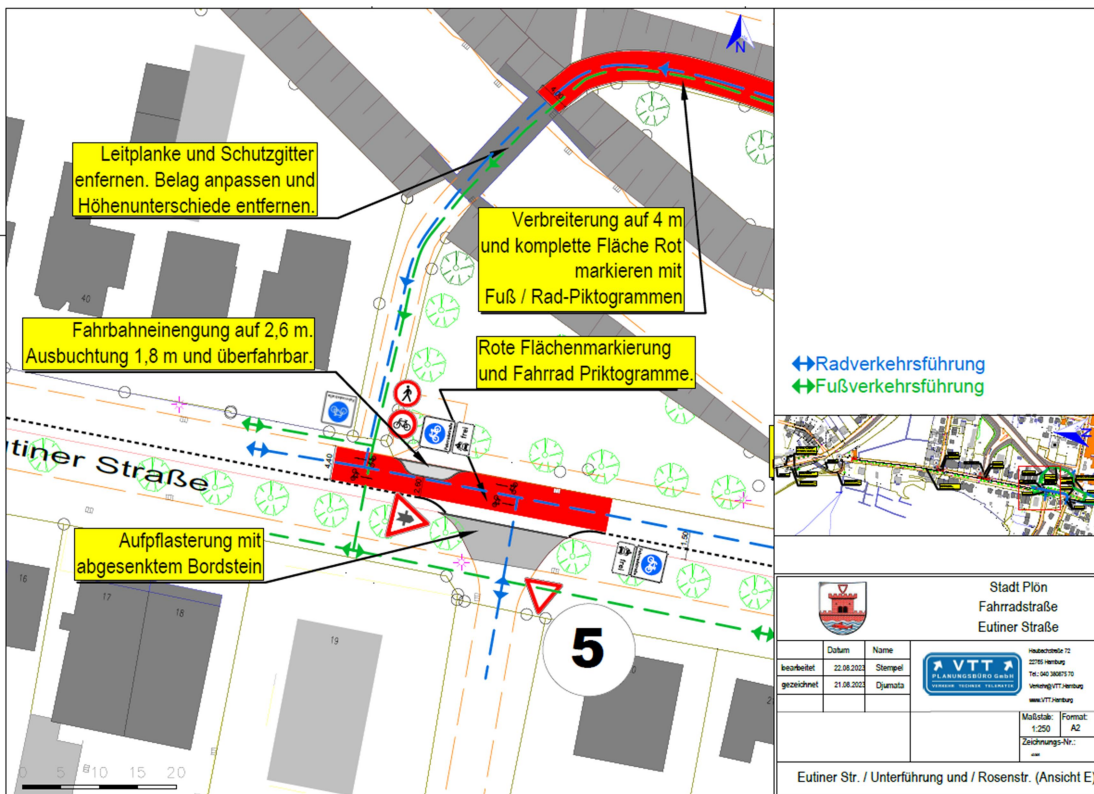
Abschnitt 5 - Eutiner Straße mit Einmündung B76 Fuß- und Radwegtunnel unter B76 / Rosenstraße
